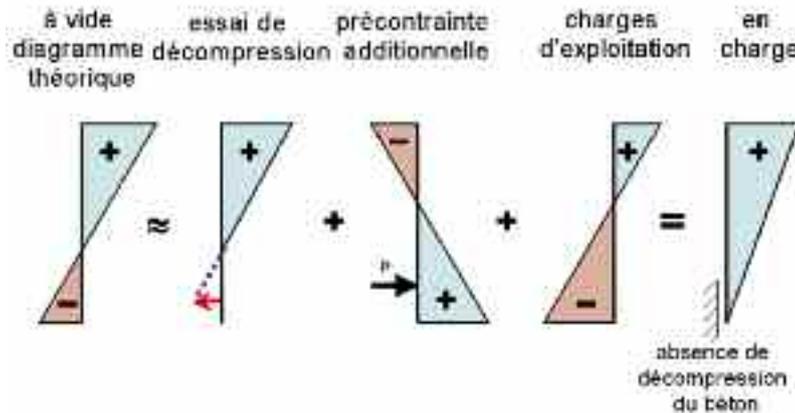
principe de renforcement d'une section fissurée à vide
